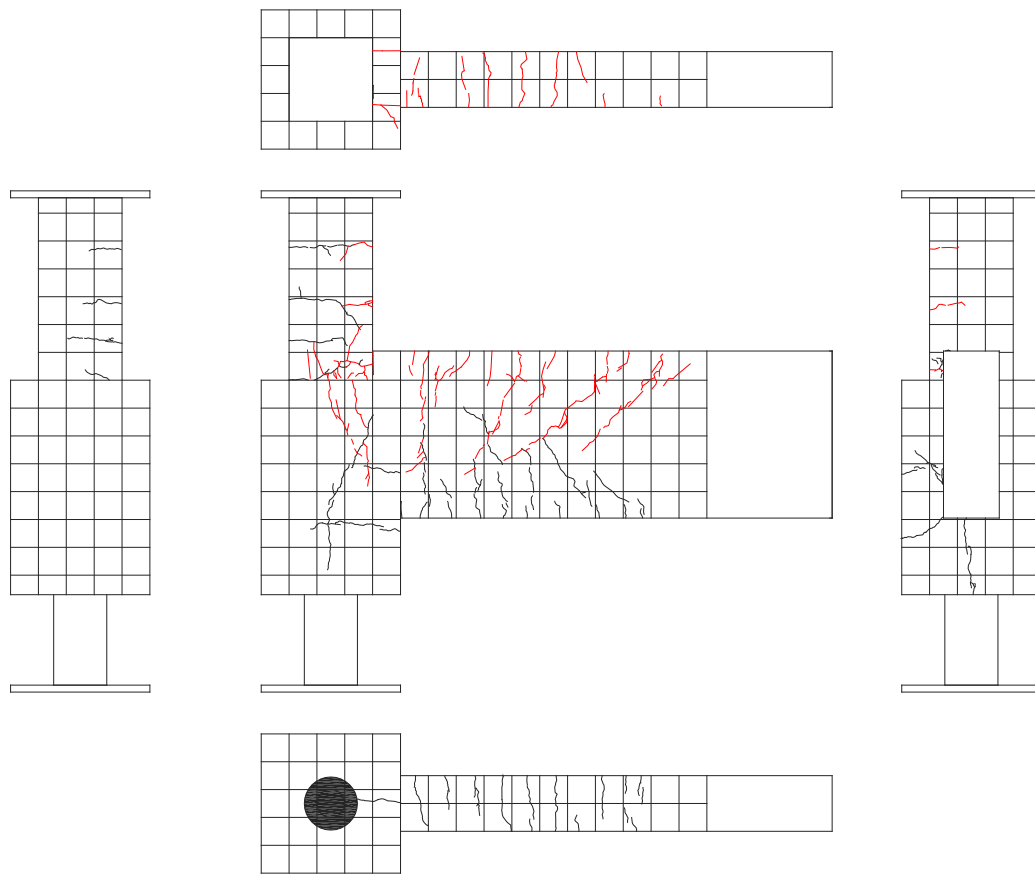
試験体 A-5 ひび割れ状況 (3Cycle)
